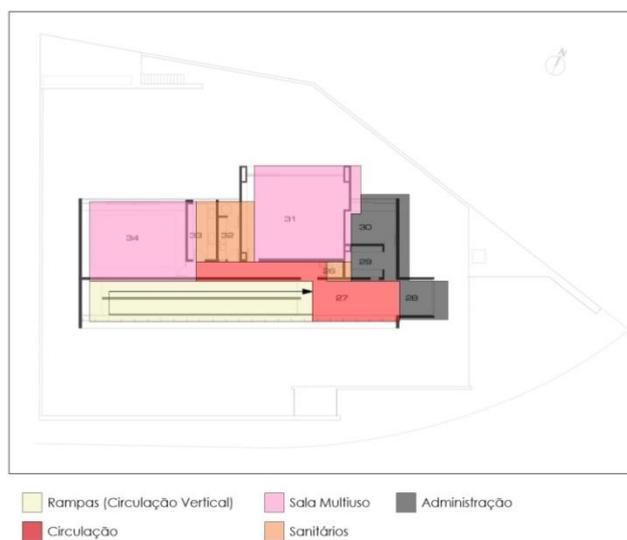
Planta Baixa 1º Pavimento - Prime Time, São Paulo.
